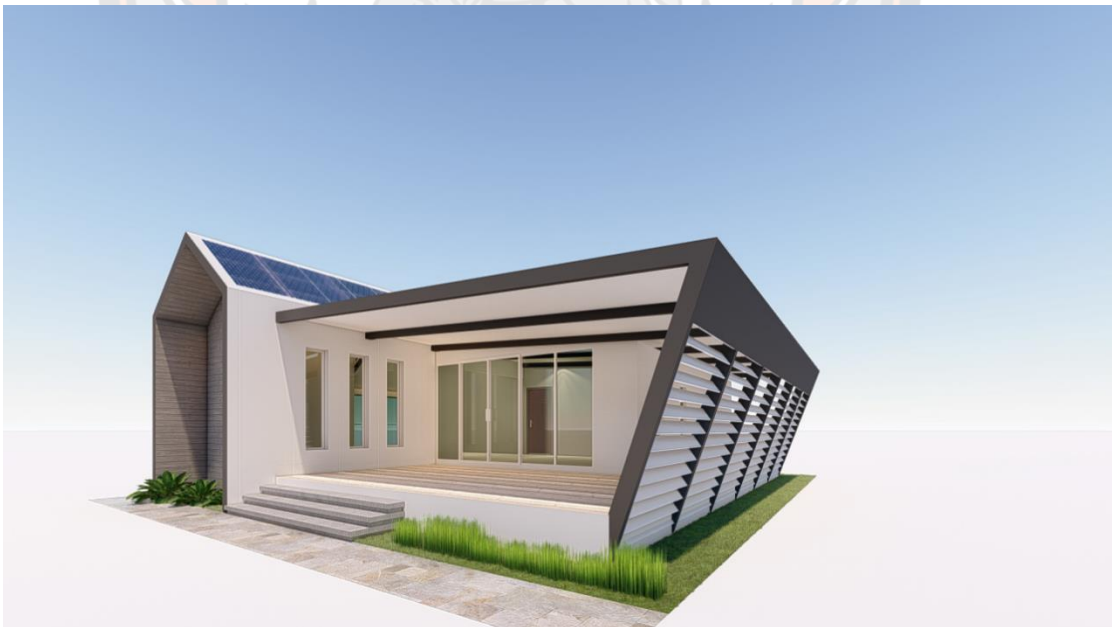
แสดงรูปด้านอาคาร 3 (Elevation-3)
